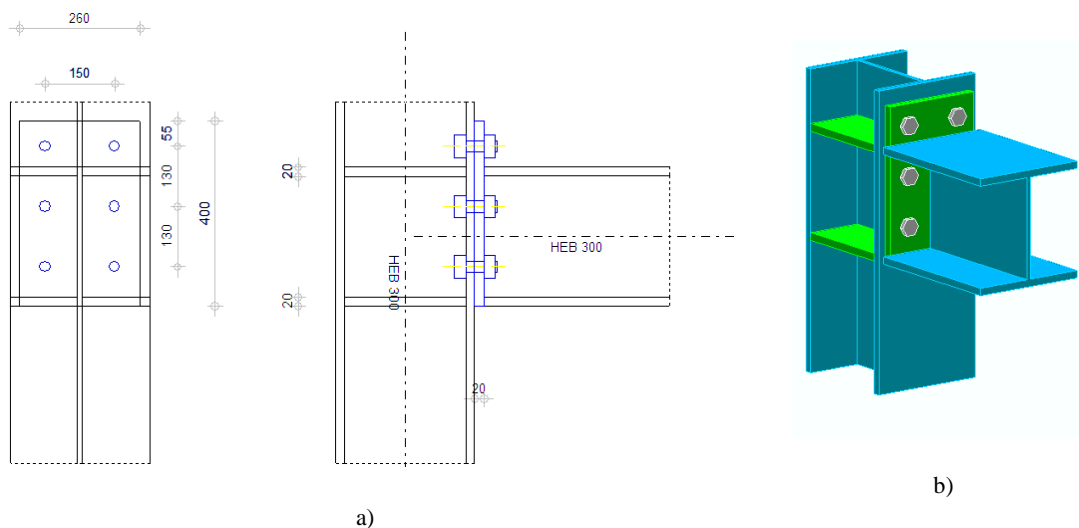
a) Esquema da ligação aparafusada coluna-viga; b) Esquema 3D da ligação aparafusada coluna-viga.
